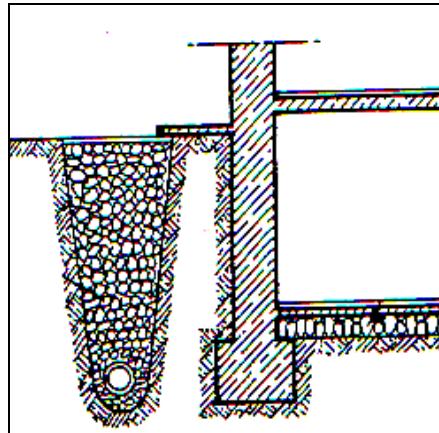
Sistema di allontanamento dell'acqua dispersa dalle pareti perimetrali: drenaggio (da: Gasparoli, 2002)
